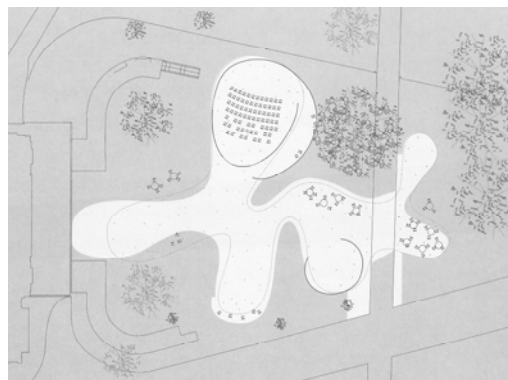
Planta, pavilhão de SANAA, 2009.
